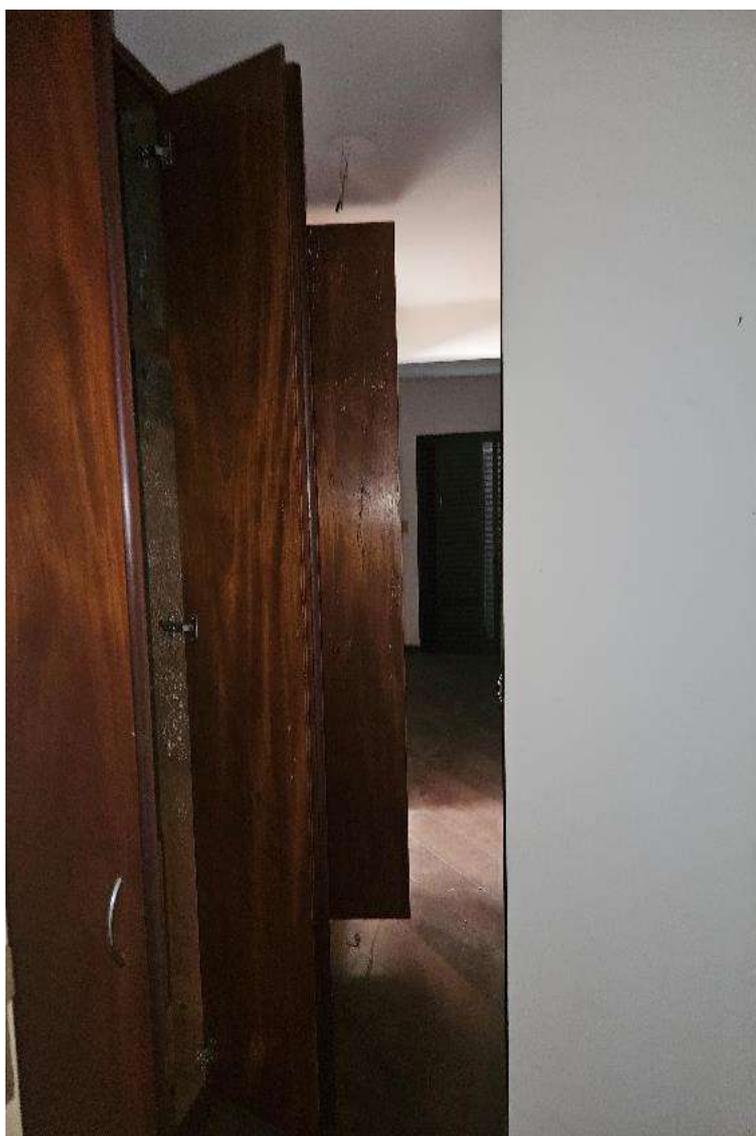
Vista do acesso ao dormitório I (suíte).
